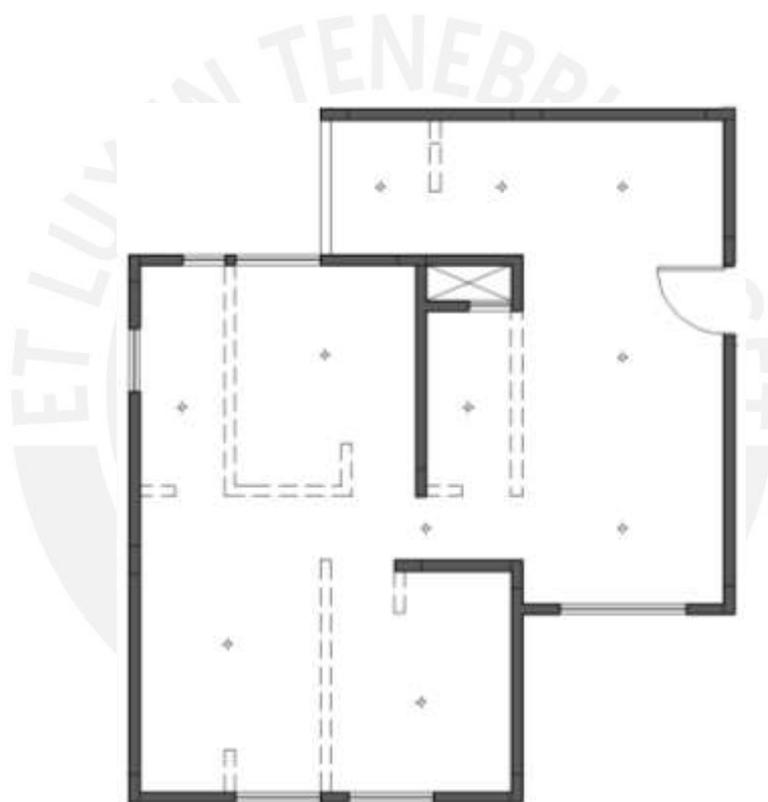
Planta de casco de vivienda, con proyección de posibles divisiones interiores.
